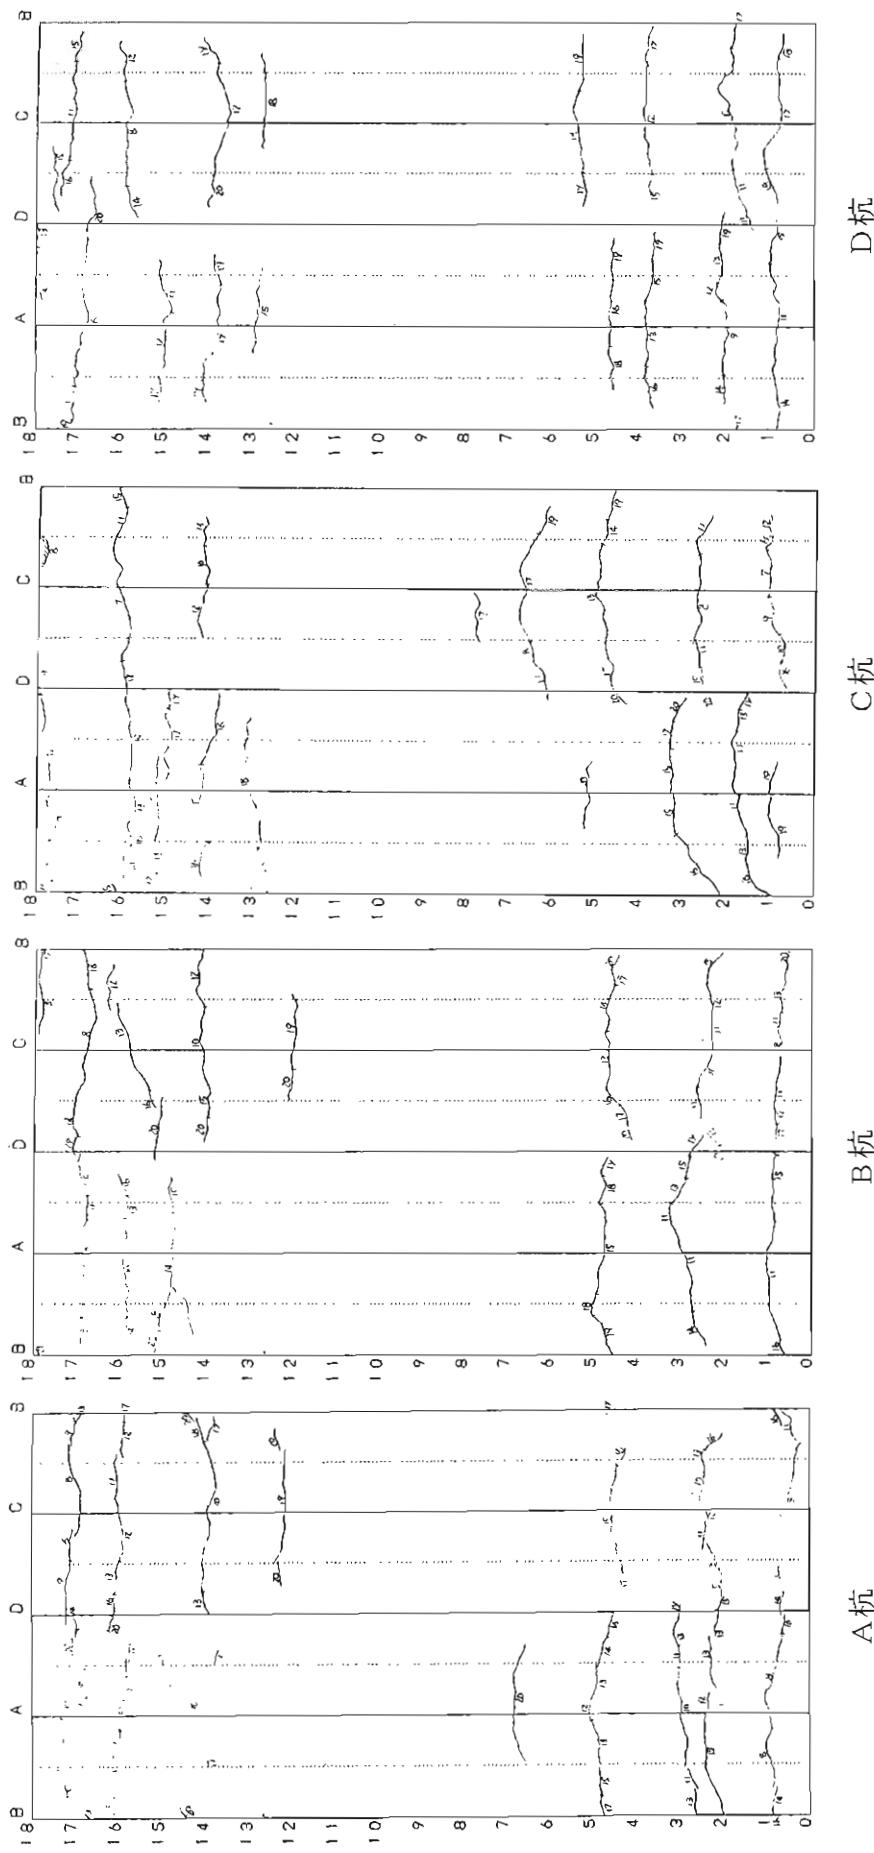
桁体のひび割れ状況展開図 (ケース9、実験終了)
